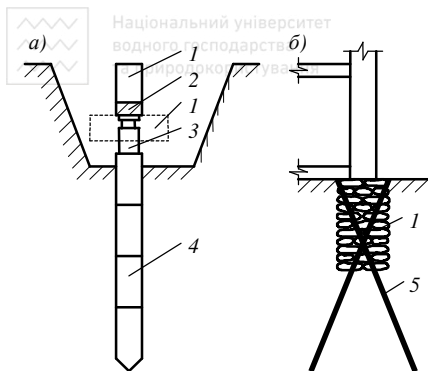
Пересадження фундаменту на палі (а) та підсилення основи і фундаменту буройн'єкційними палями (б):
